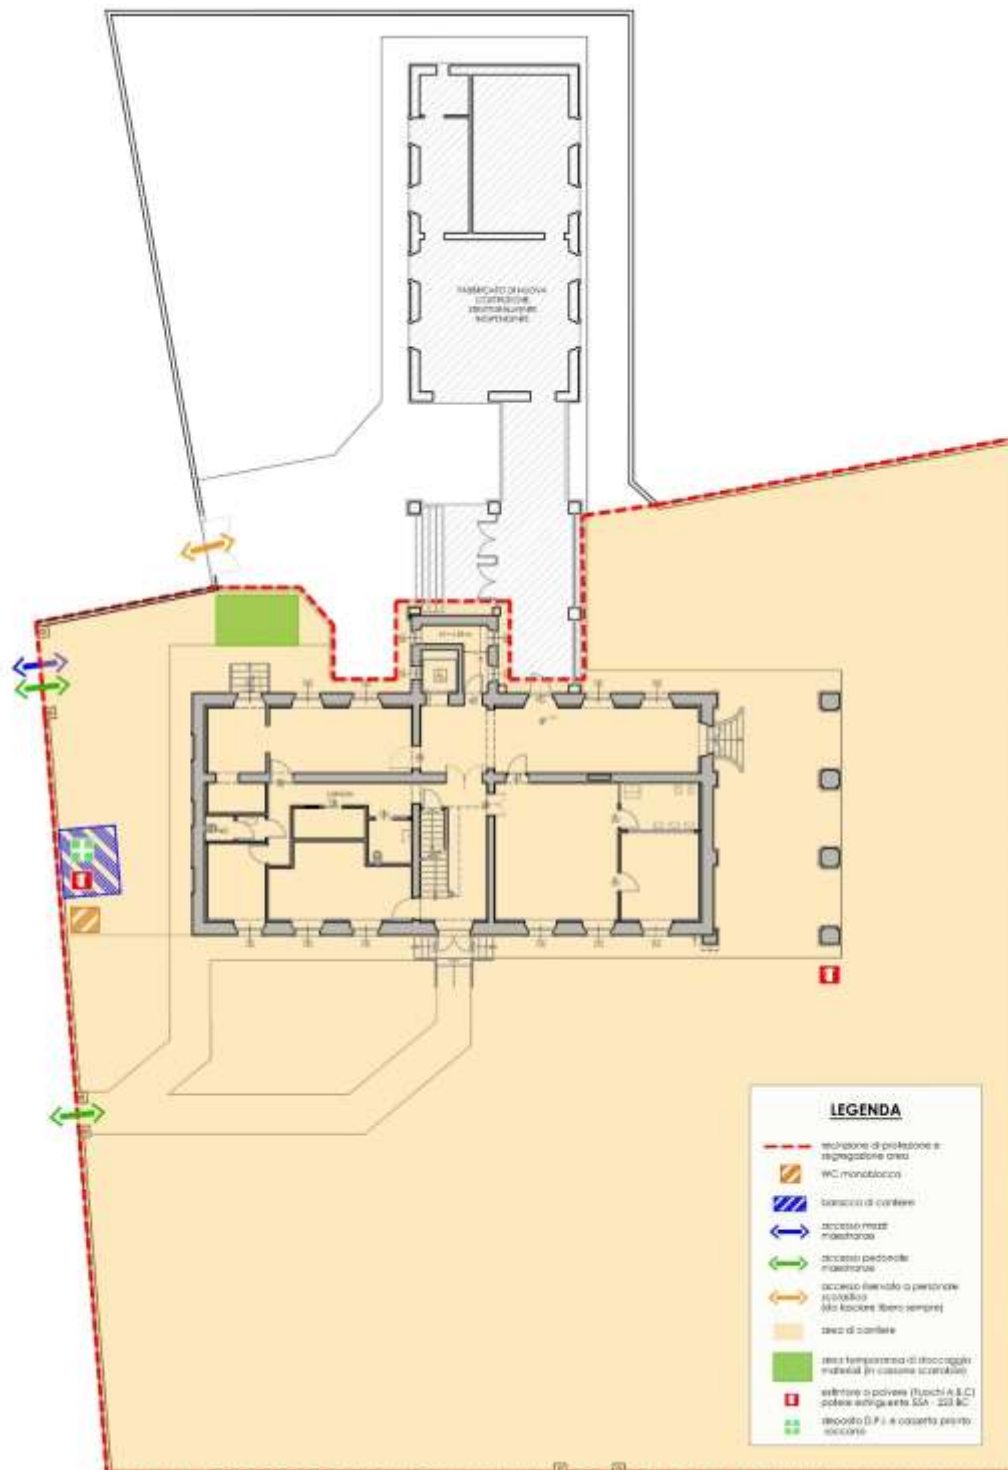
PLANIMETRIA DI CANTIERE FASE A
